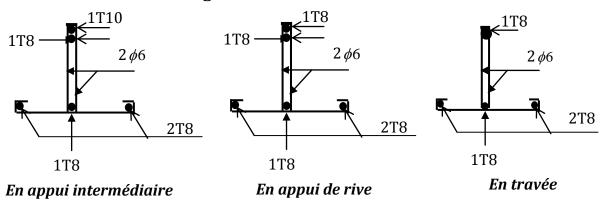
Schémas de Ferraillage des Poutrelles de planchers étage courant
